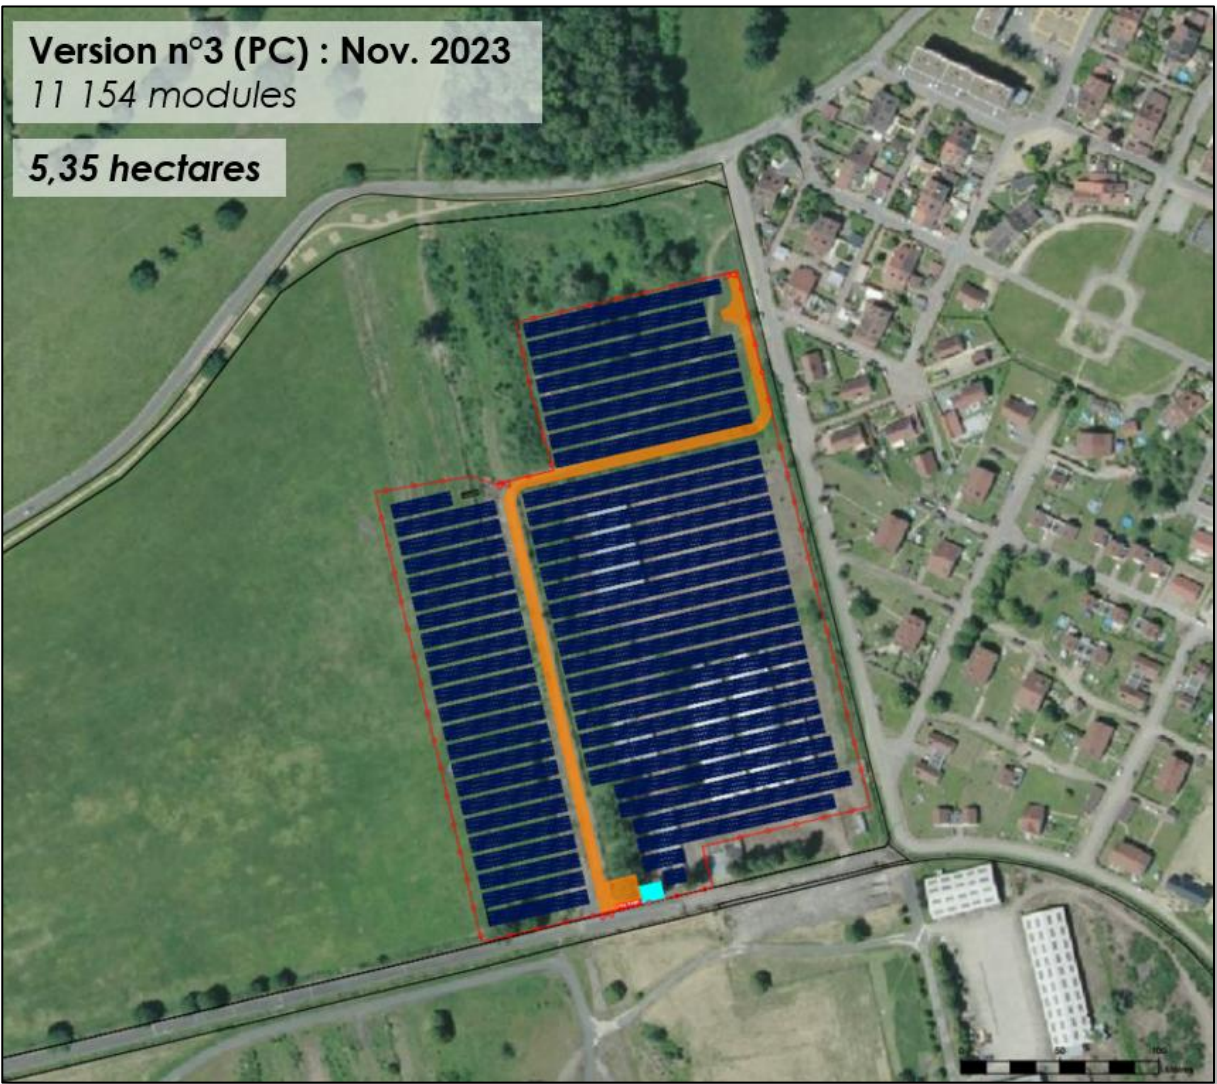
Plan masse de la variante 3 de l'implantation (implantation finale) (Source : ELEMENTS).
